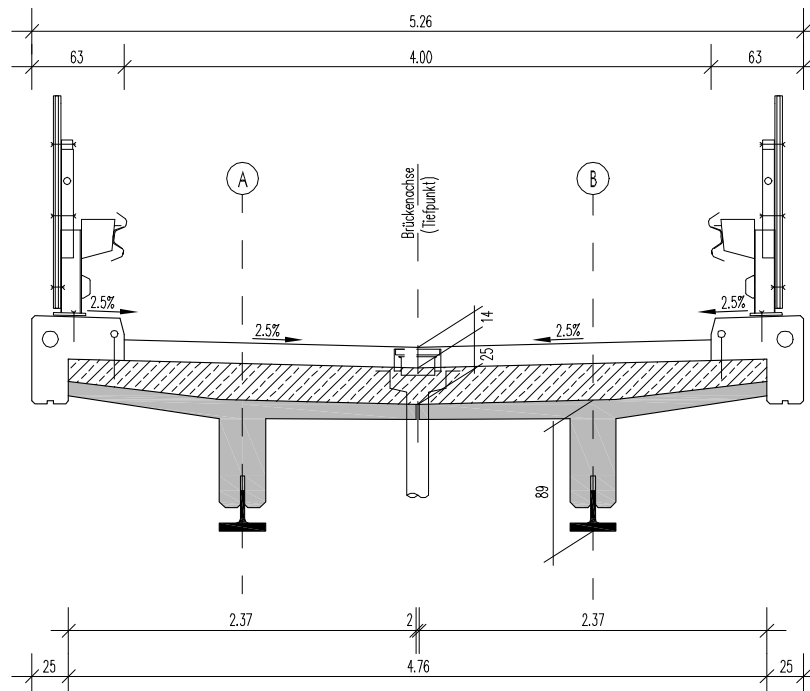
Querschnitt der Brücke in Vigaun (A) mit Betonsteg und untenliegendem Stahlträger
